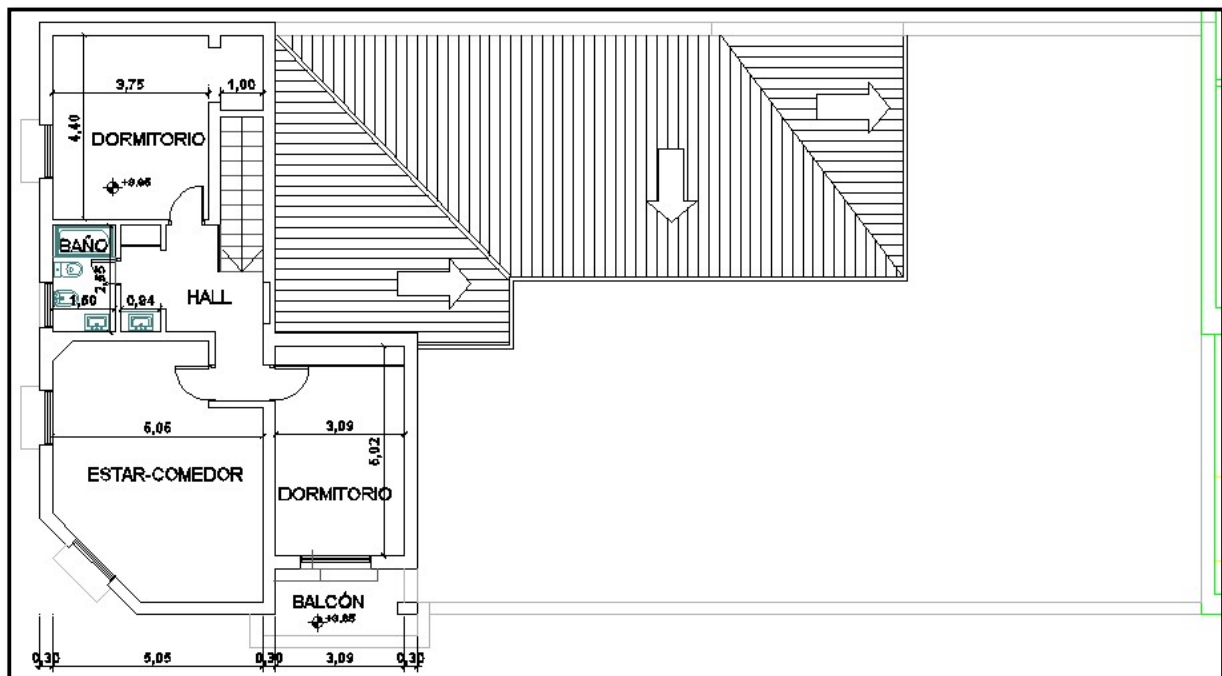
Plano de planta alta luego de la re funcionalización.
